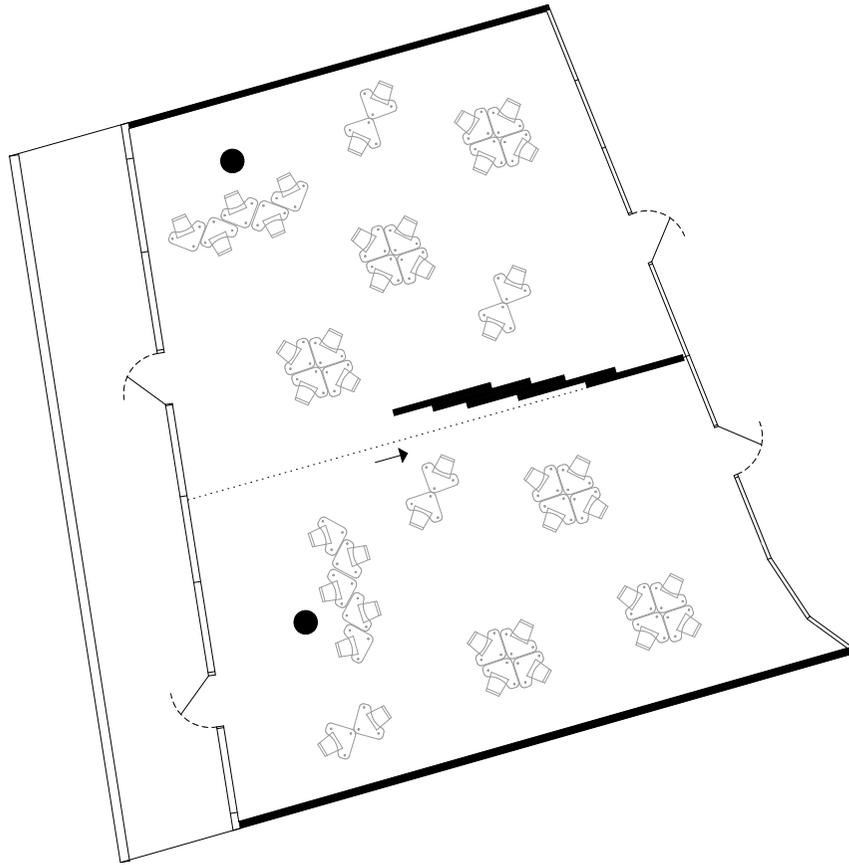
Bildungsraum mit Schiebewände - Grundriss
